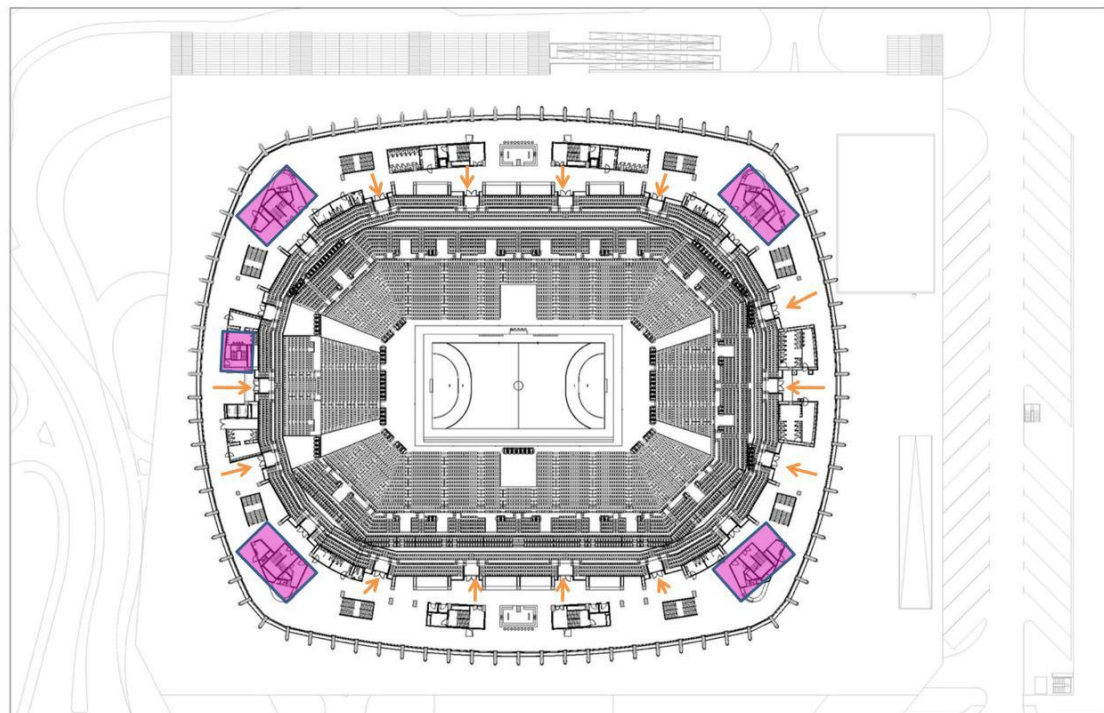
Plan du 3eme étage, Arena, Zagreb, Croatie.
